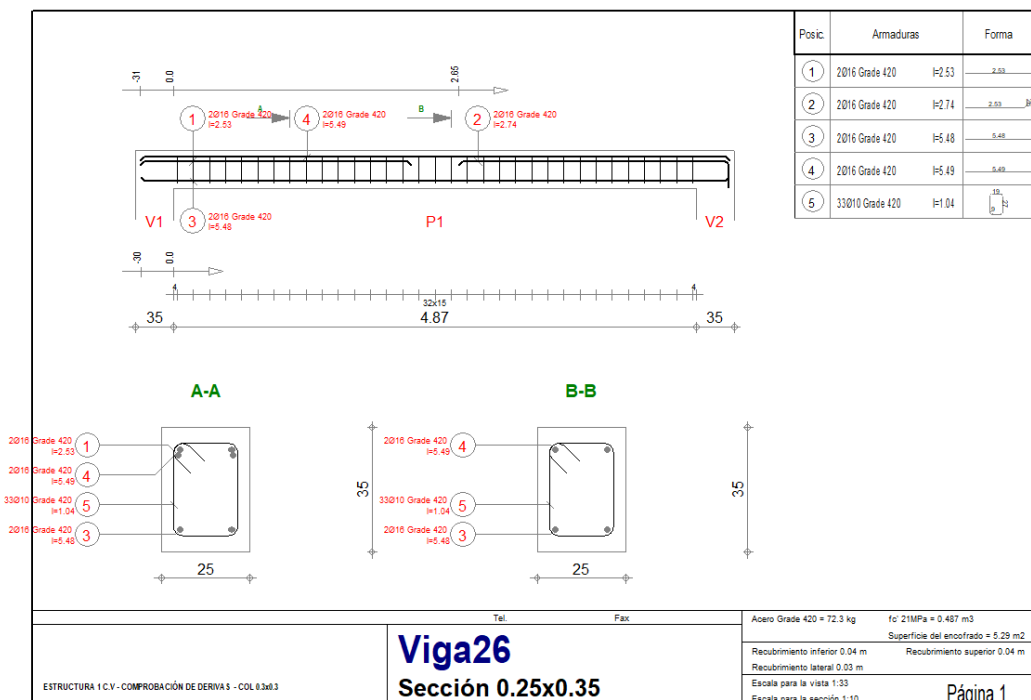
Despiece estructural de la viga 26 de la estructura 1 del Centro Vida.
